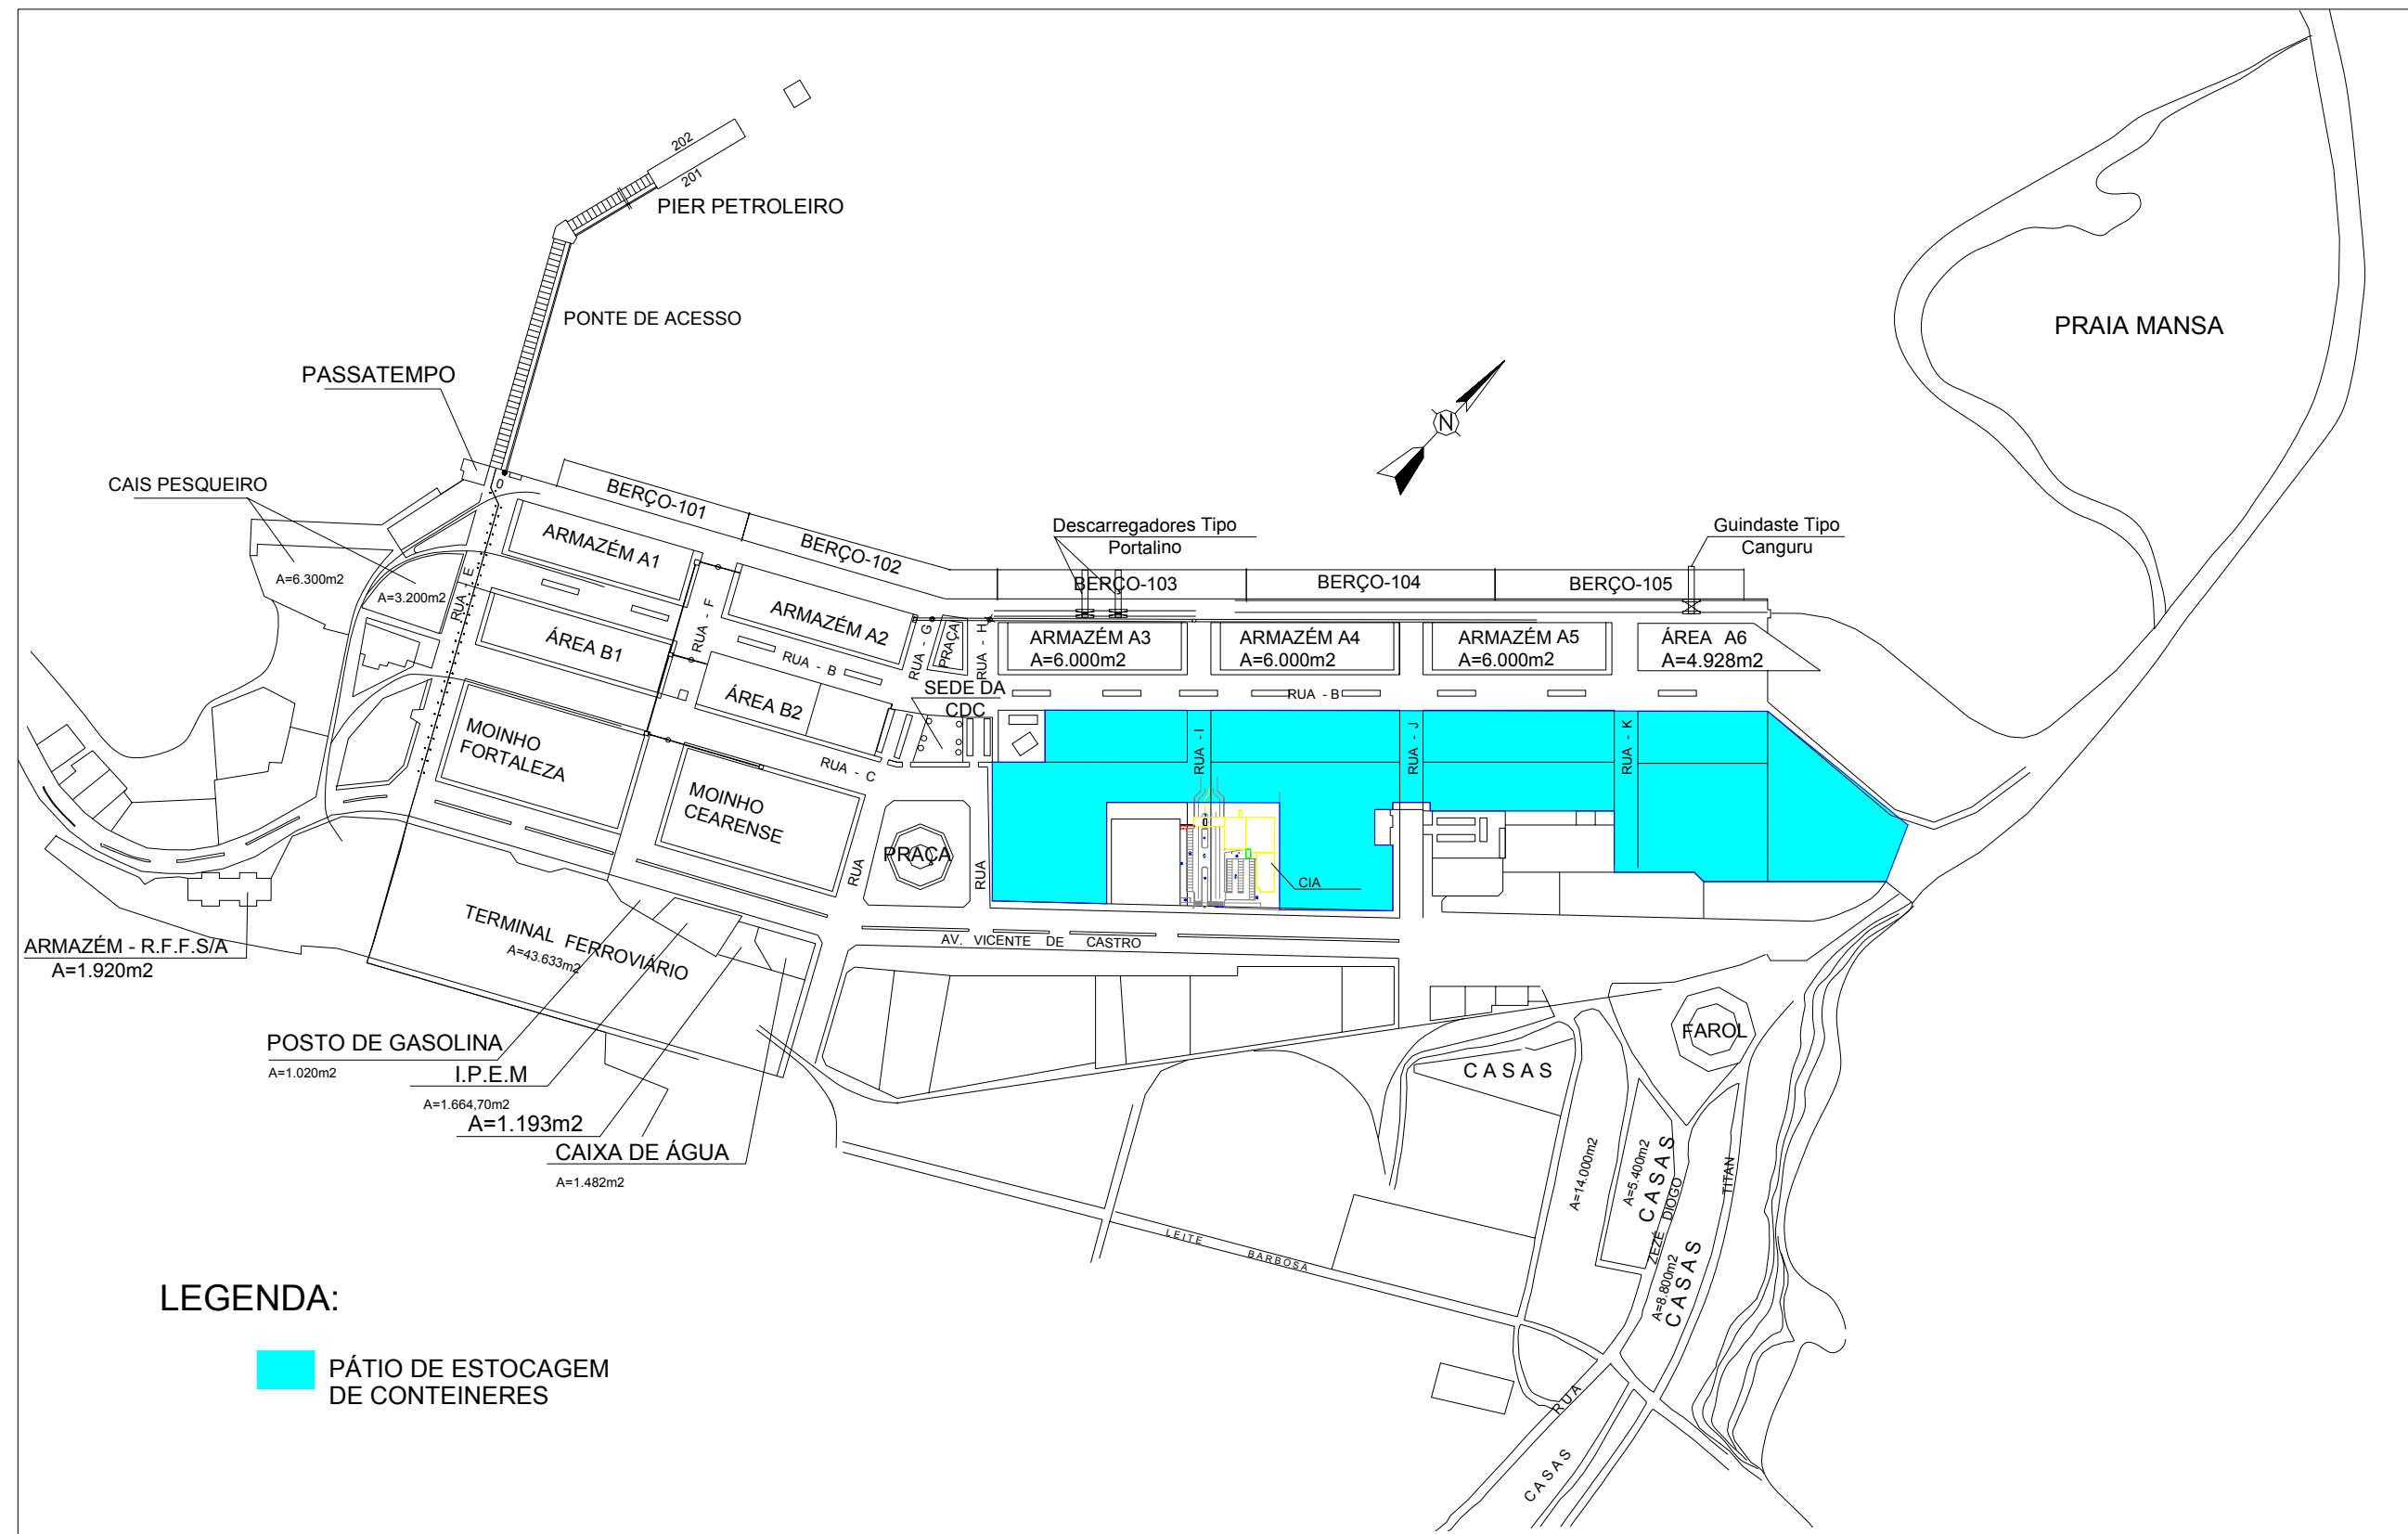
Planta geral do Porto de Fortaleza (adaptado de CDC, 2008)
